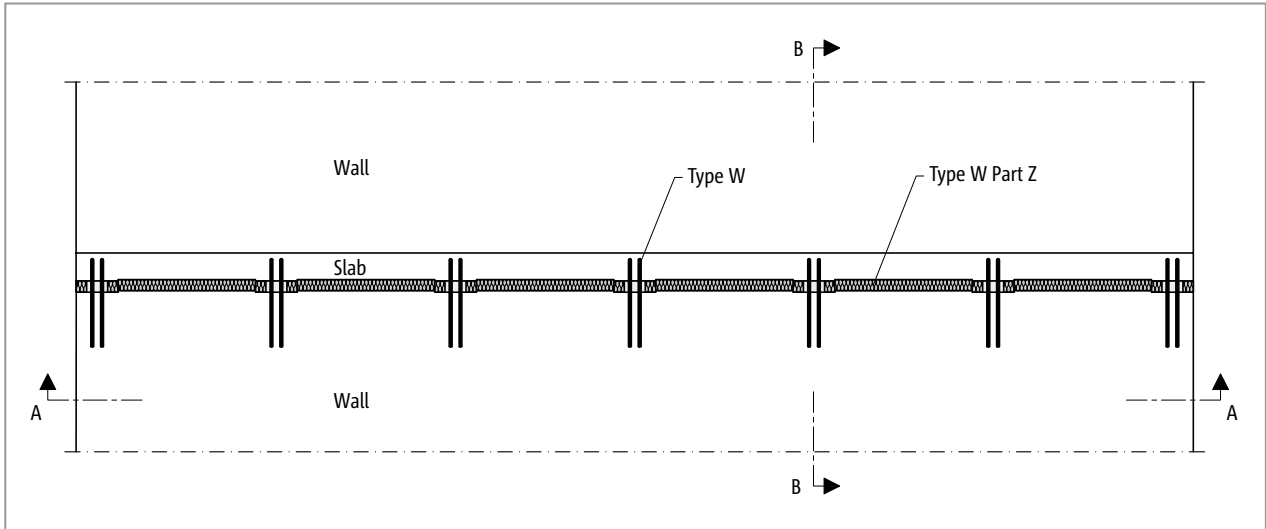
Schöck Sconnex® type W: Connection between wall and slab above – installation at the top of the wall
